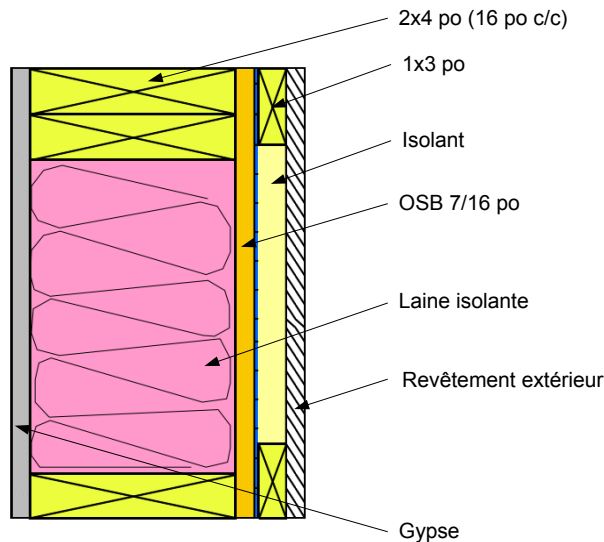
Coupe de mur préfabriqué en 2 po x 4 po.
